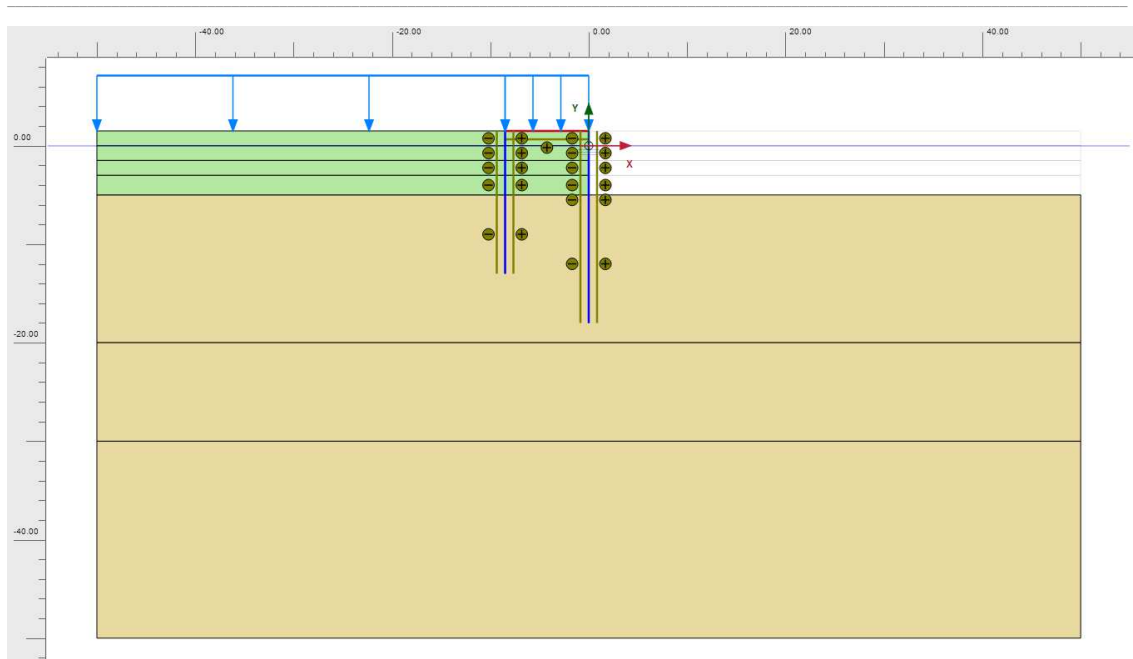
Sezione 3 – Modello geotecnico di calcolo
